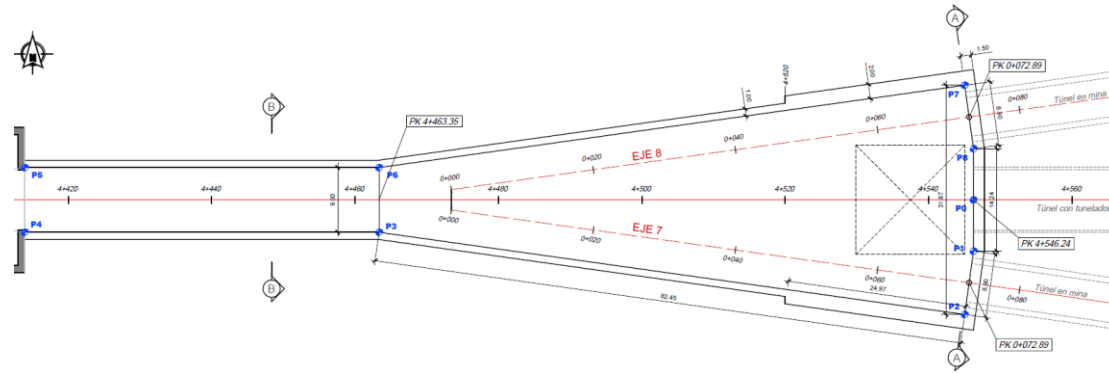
Planta Telescopio-1 y PET-2 (Alt. 2-4)
